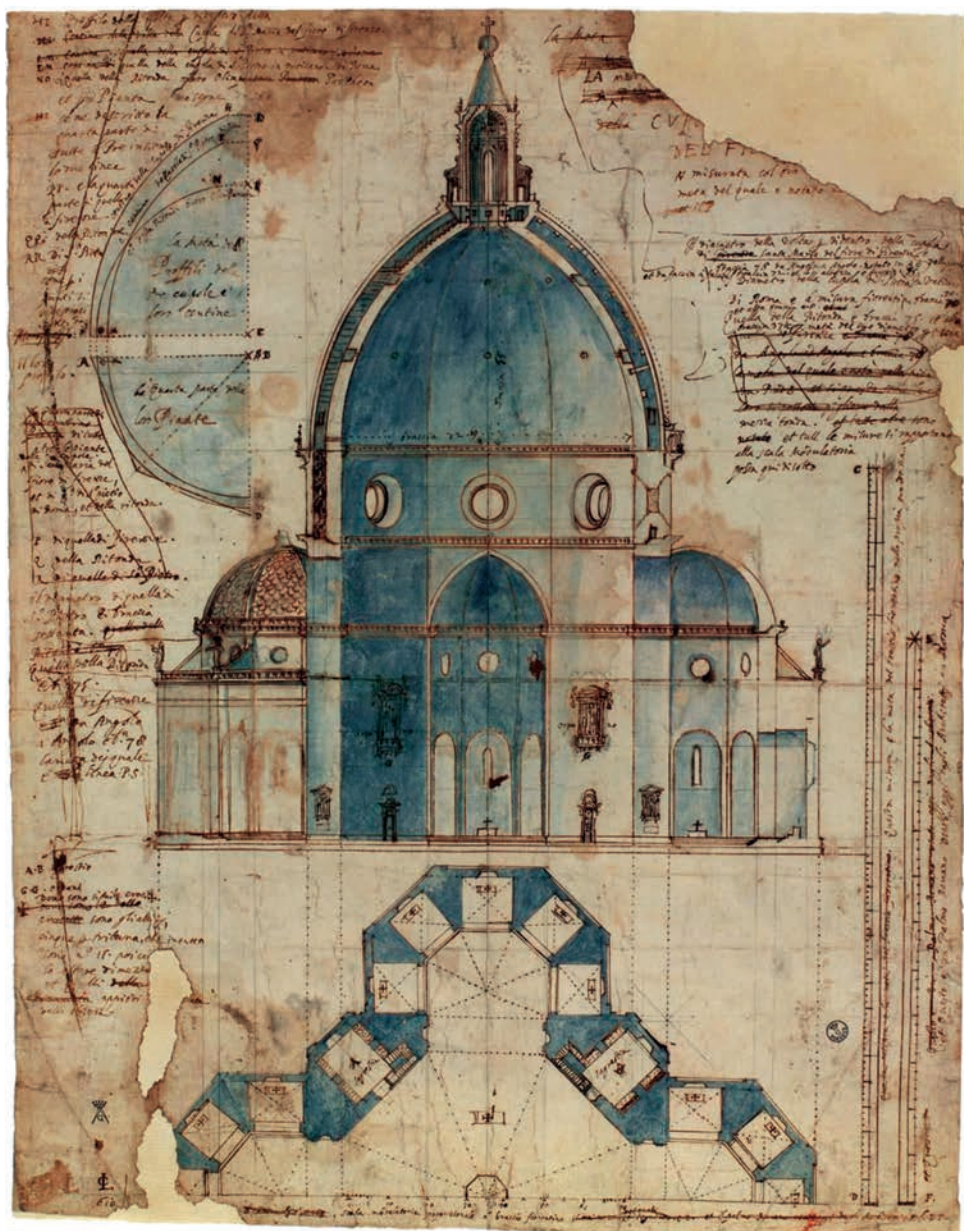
Desenho (planta baixa, elevação e seção transversal) do projeto de Brunelleschi para o Domo de Santa Maria del Fiore (c. 1613). Cigoli, Florença.
